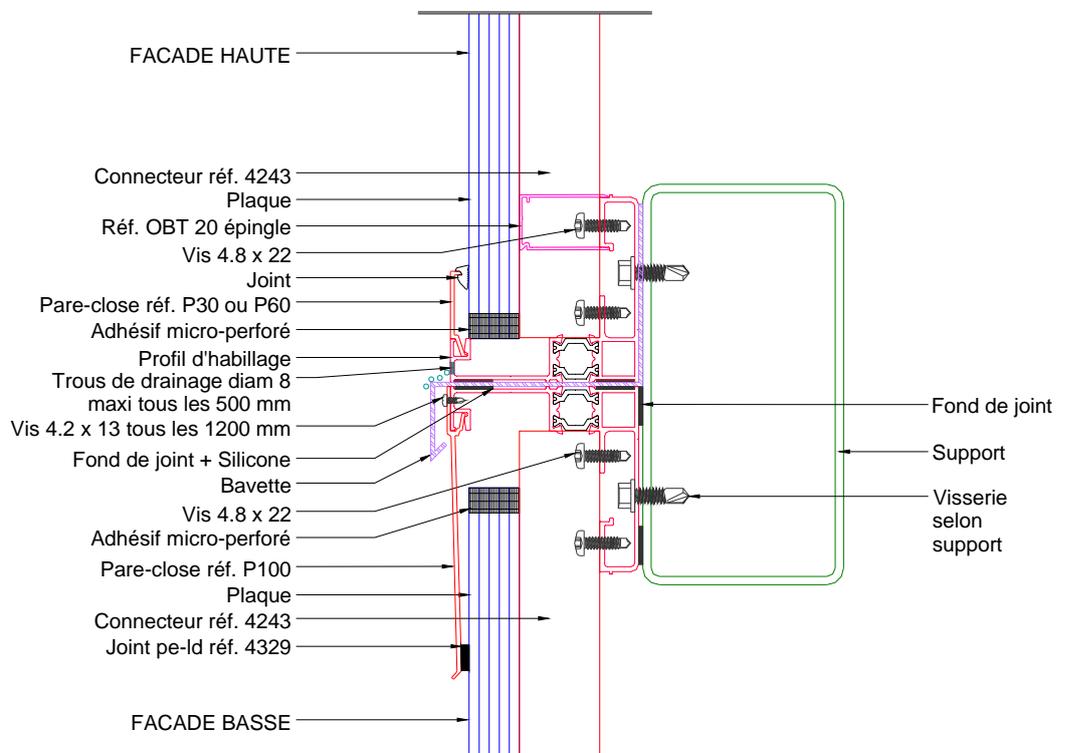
Pose normale - Raccord de hauteur n°2 : façade basse limitée à 10 mètres de haut
